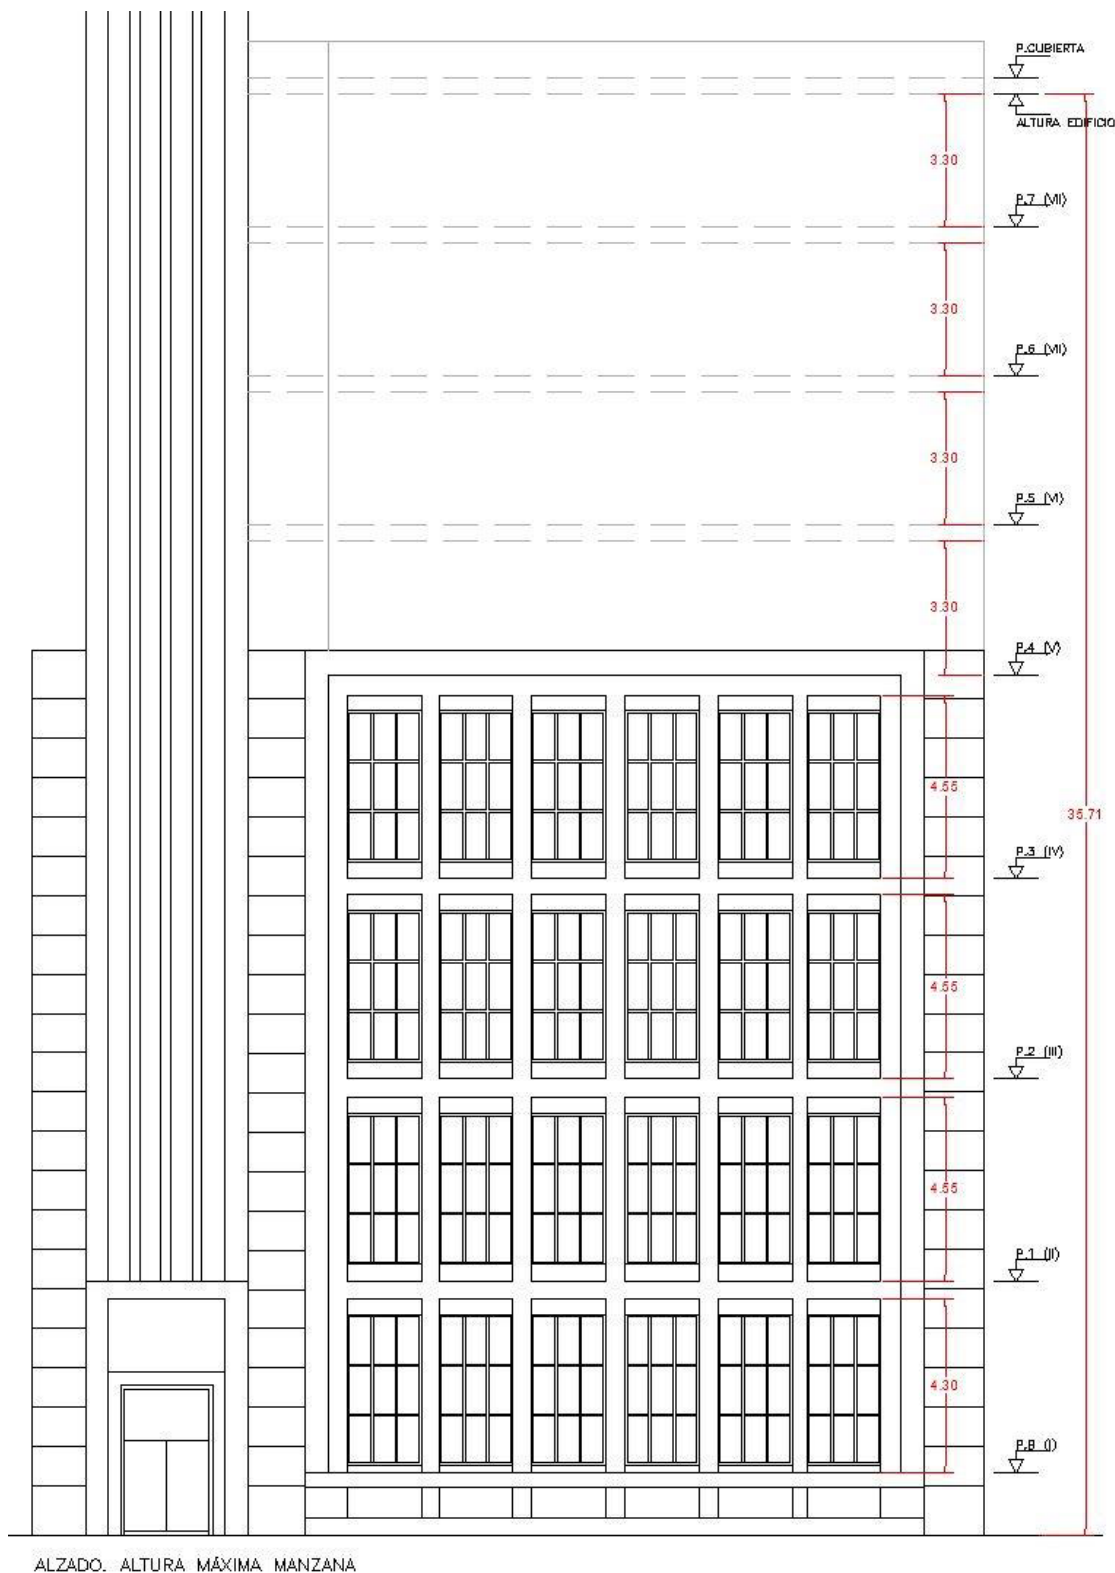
Alzado de edificación según altura de manzana (8 alturas) (detalle)
